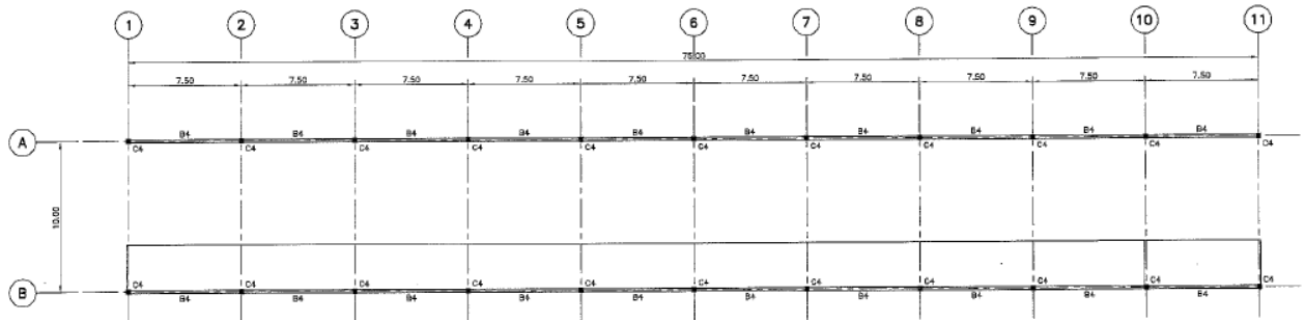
แบบโครงสร้าง Stabling Building
